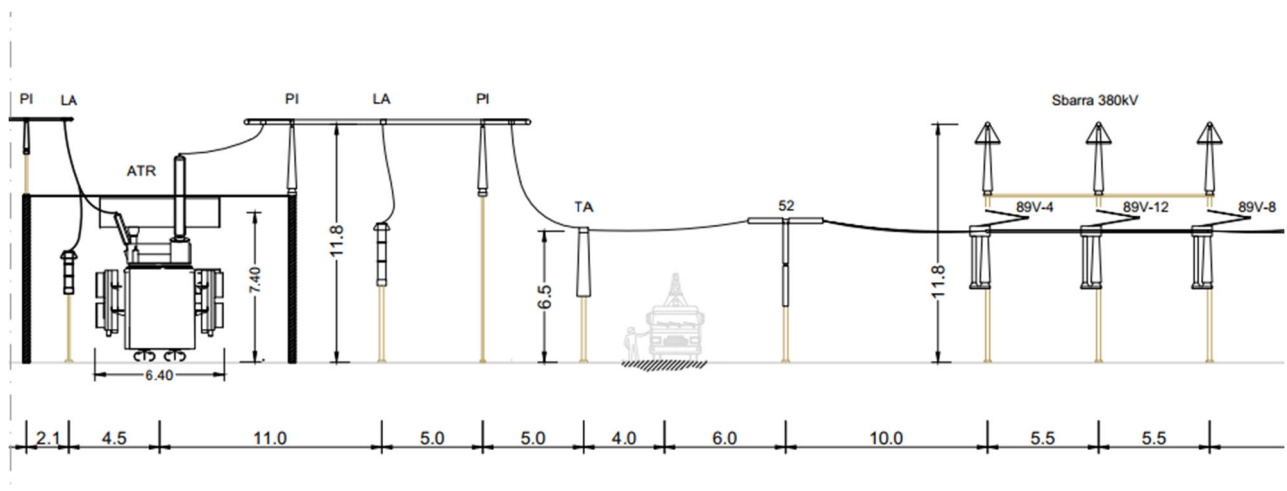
Stazione Sud – sezione trasversale montante ATR 380 kV
